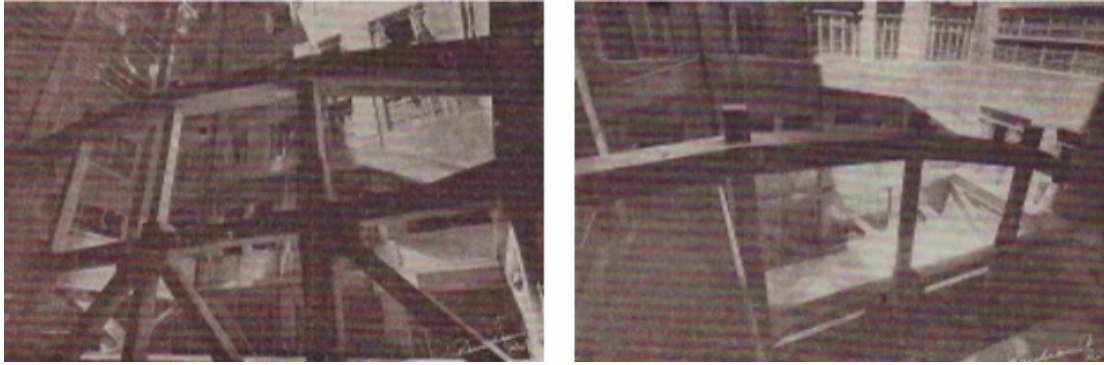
Edifício Rex, 1930. Arco treliçado em concreto armado configurando a estrutura de transição do andar superior. FONTE: CONCRETO, 1945.
